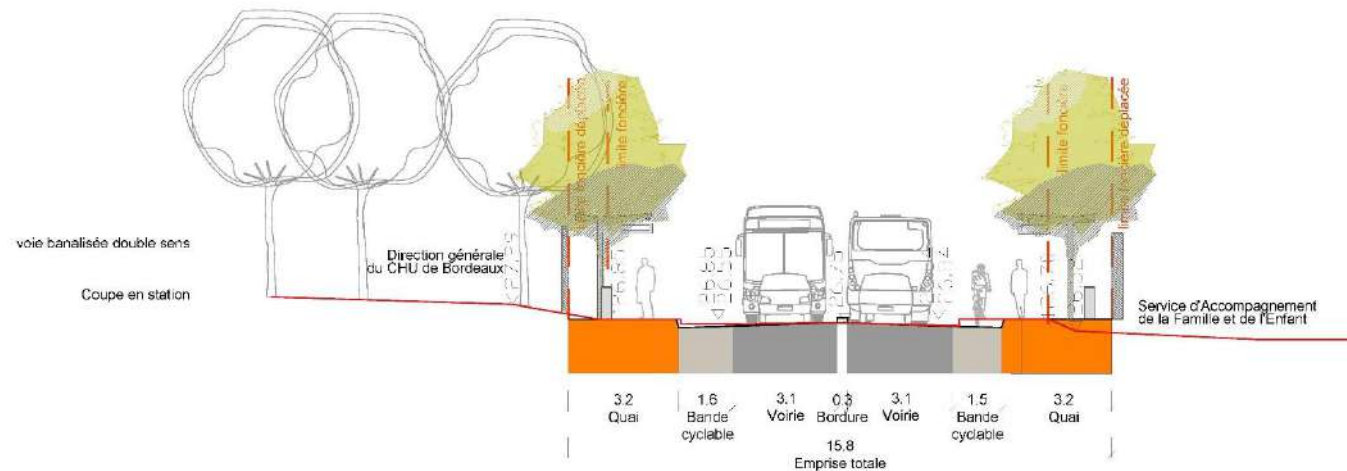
Coupe type sur l’avenue de la Vieille Tour
